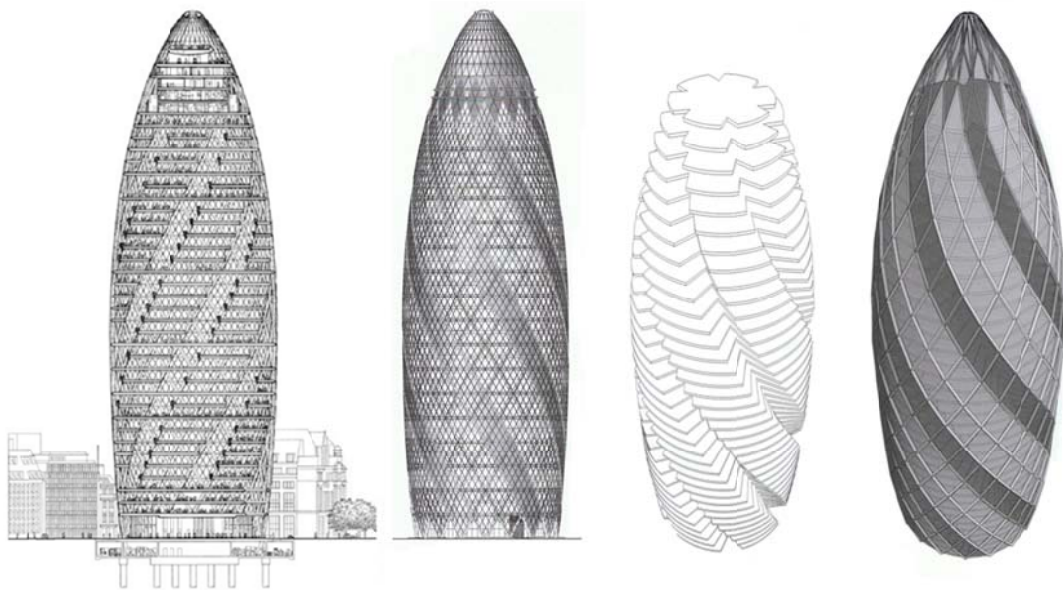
Sección, alzado y perspectivas de la torre Swiss Re de Norman Foster. Fuente: © Norman Foster
